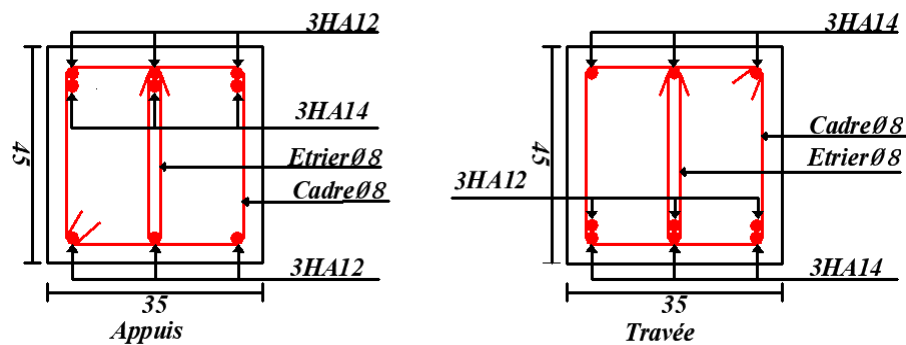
Schéma de ferrailage de la poutre principale du plancher terrasse
